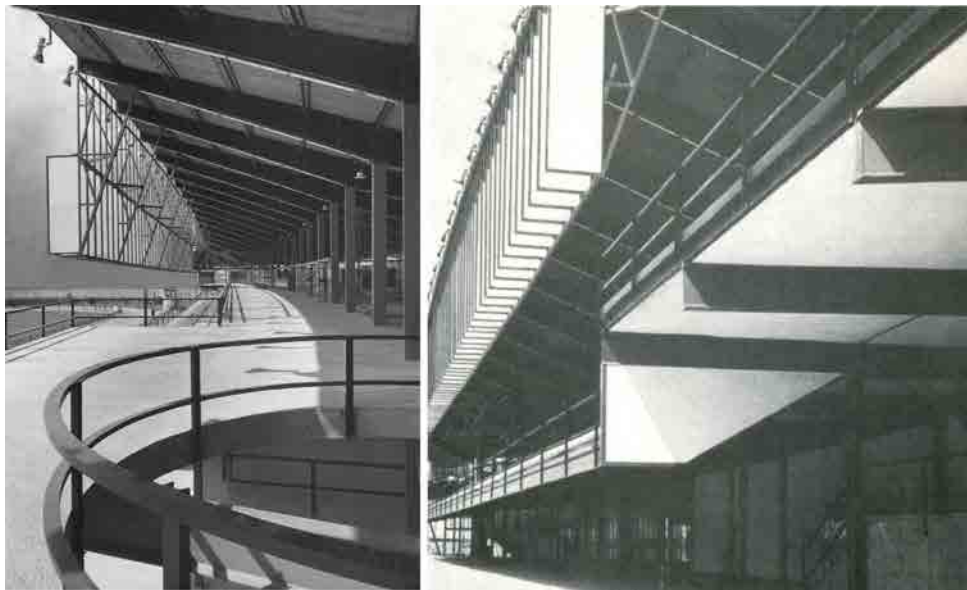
Contrapeso de estructura. Fuente: www.hicarquitectura.com
